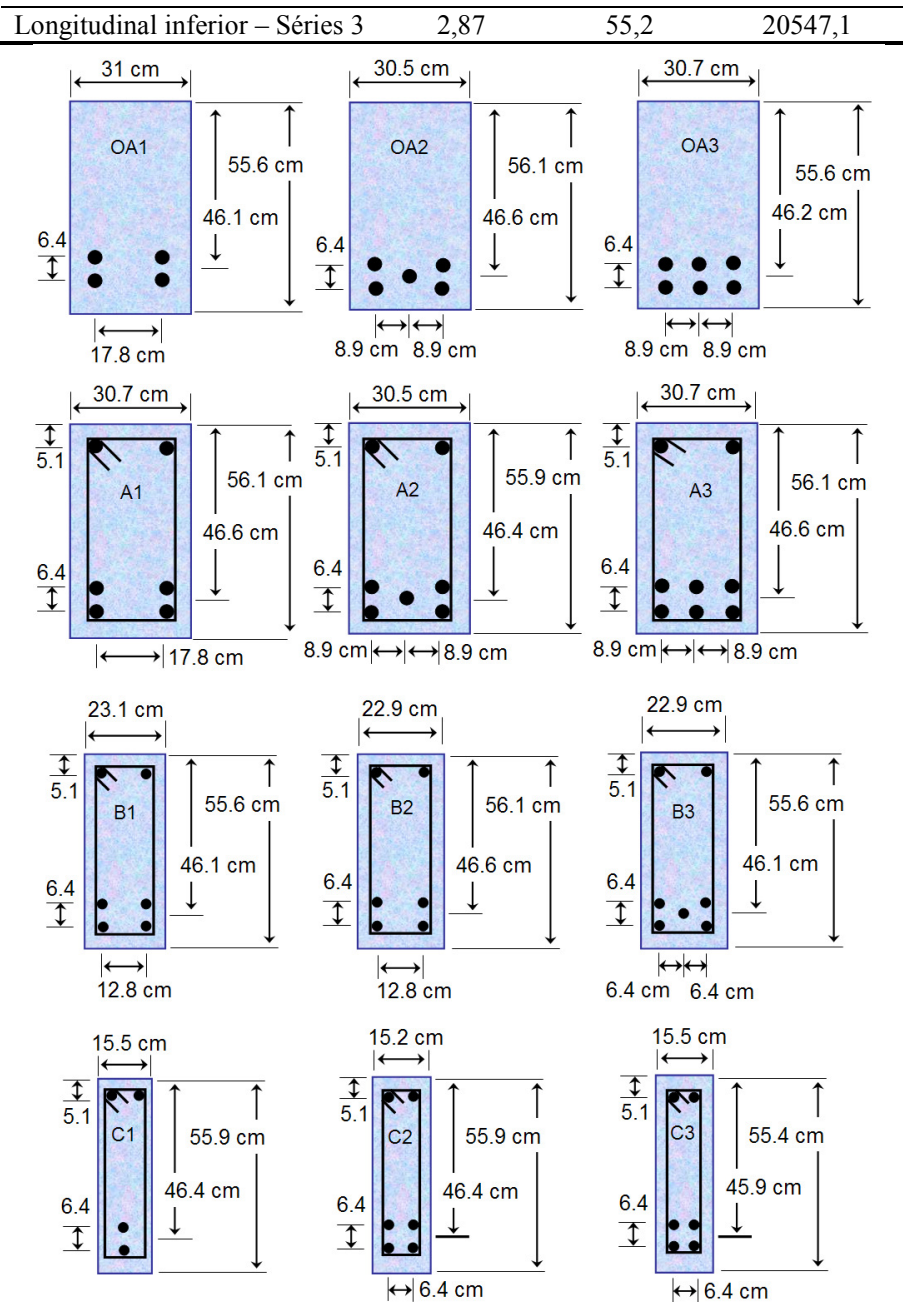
Detalhes das seções transversais das vigas de Bresler e Scordelis (1963).
